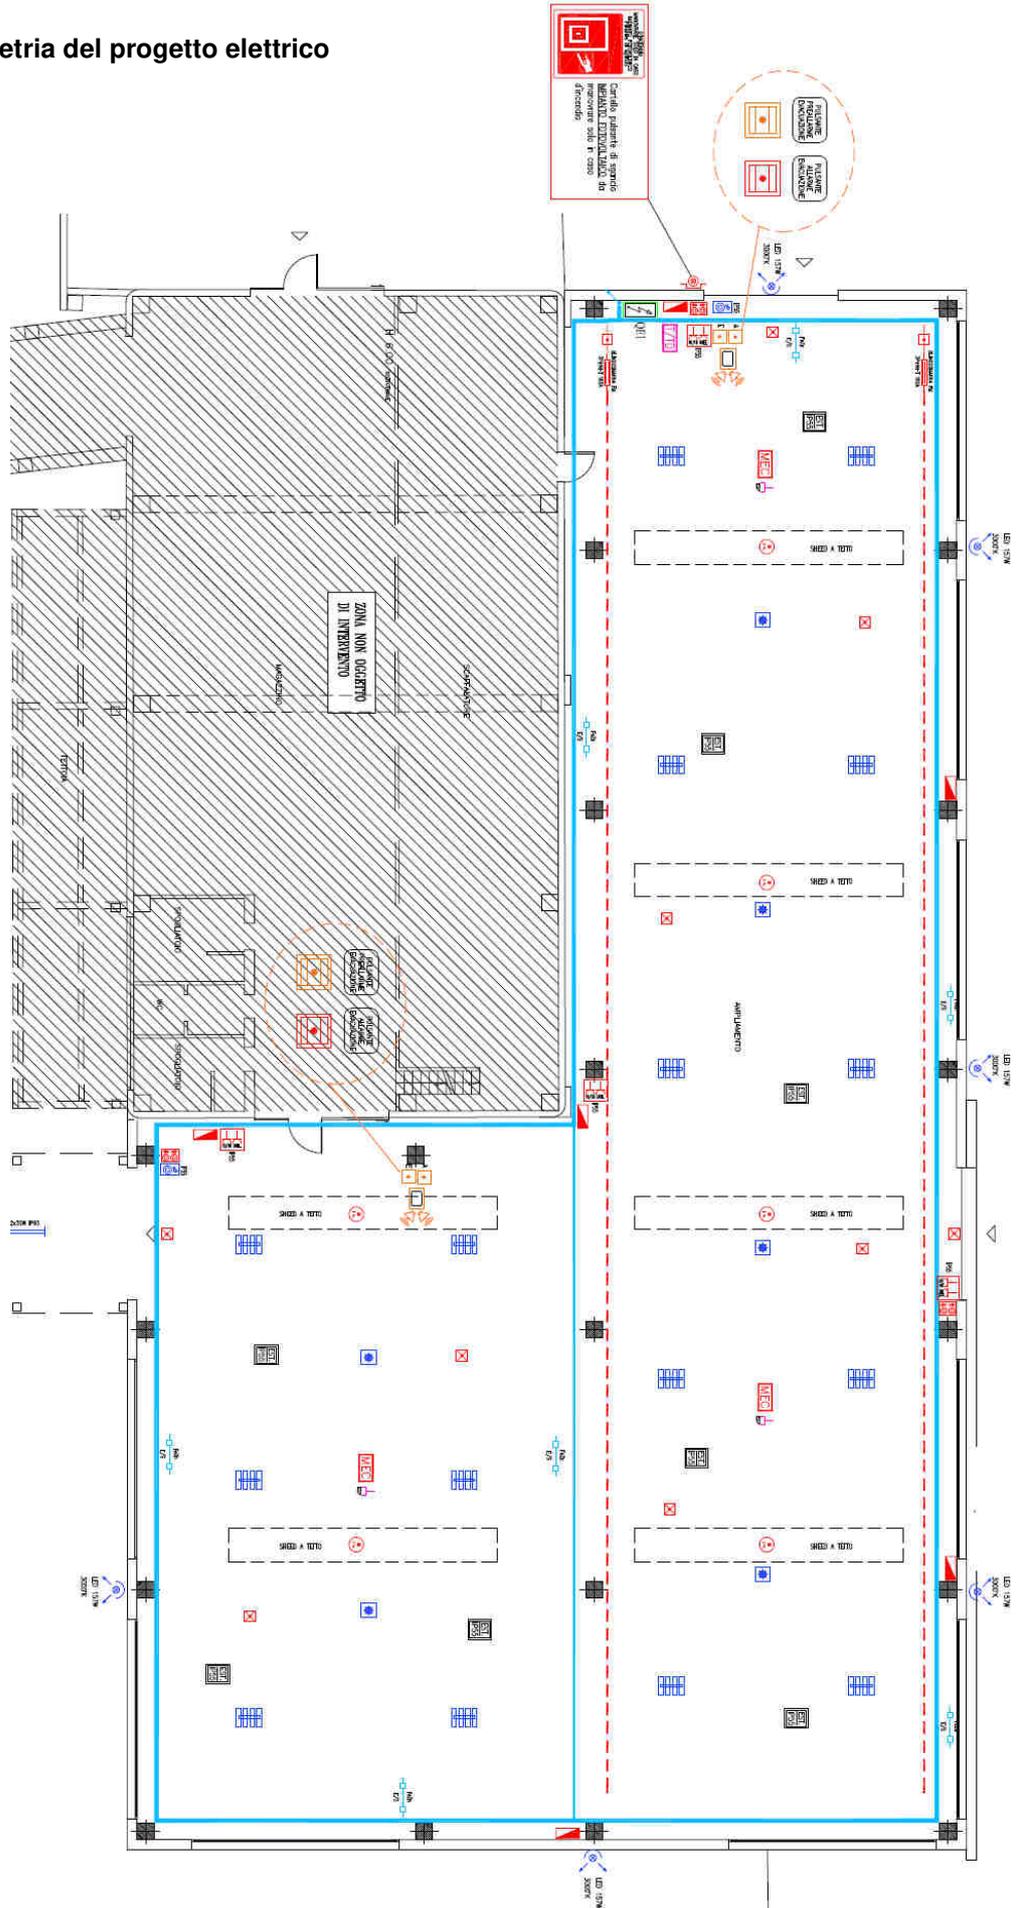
Planimetria del progetto elettrico: quadri elettrici in ampliamento
